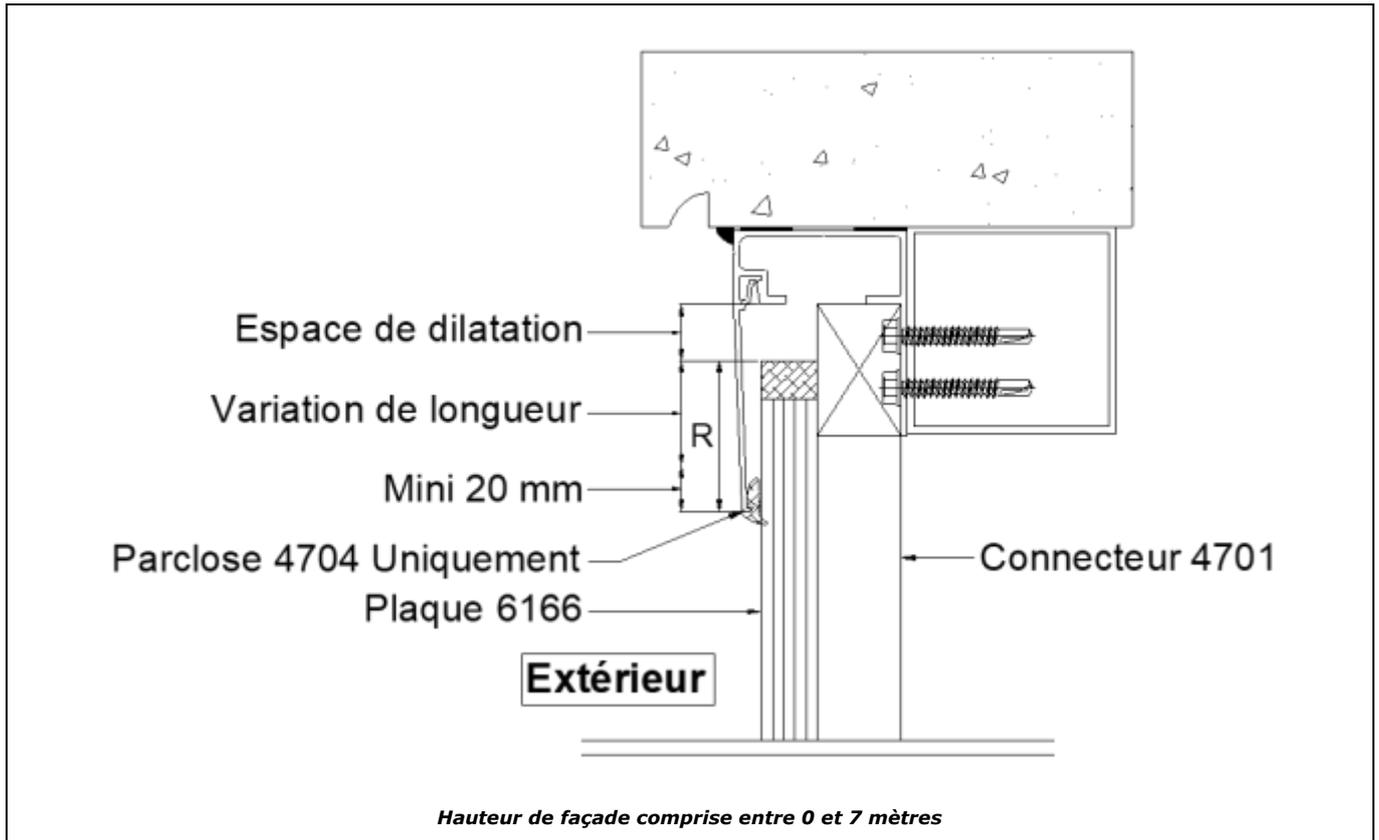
Mise en œuvre : recouvrement (mm) en tête de façade
